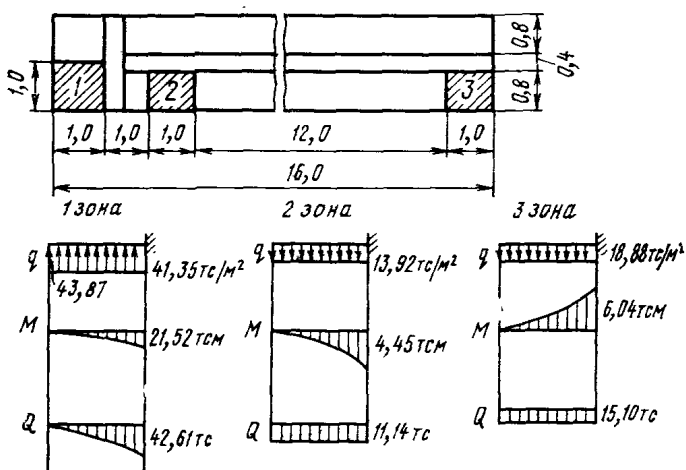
Схемы расчета сечений трех зон фундаментной плиты
